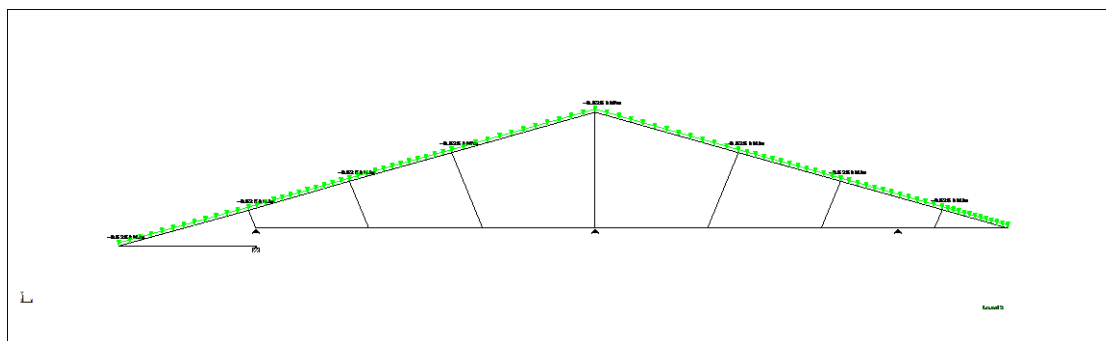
Cargas Vivas. Fuente: Elaboración propia con Software STAAD.Pro Design of the Structure.
